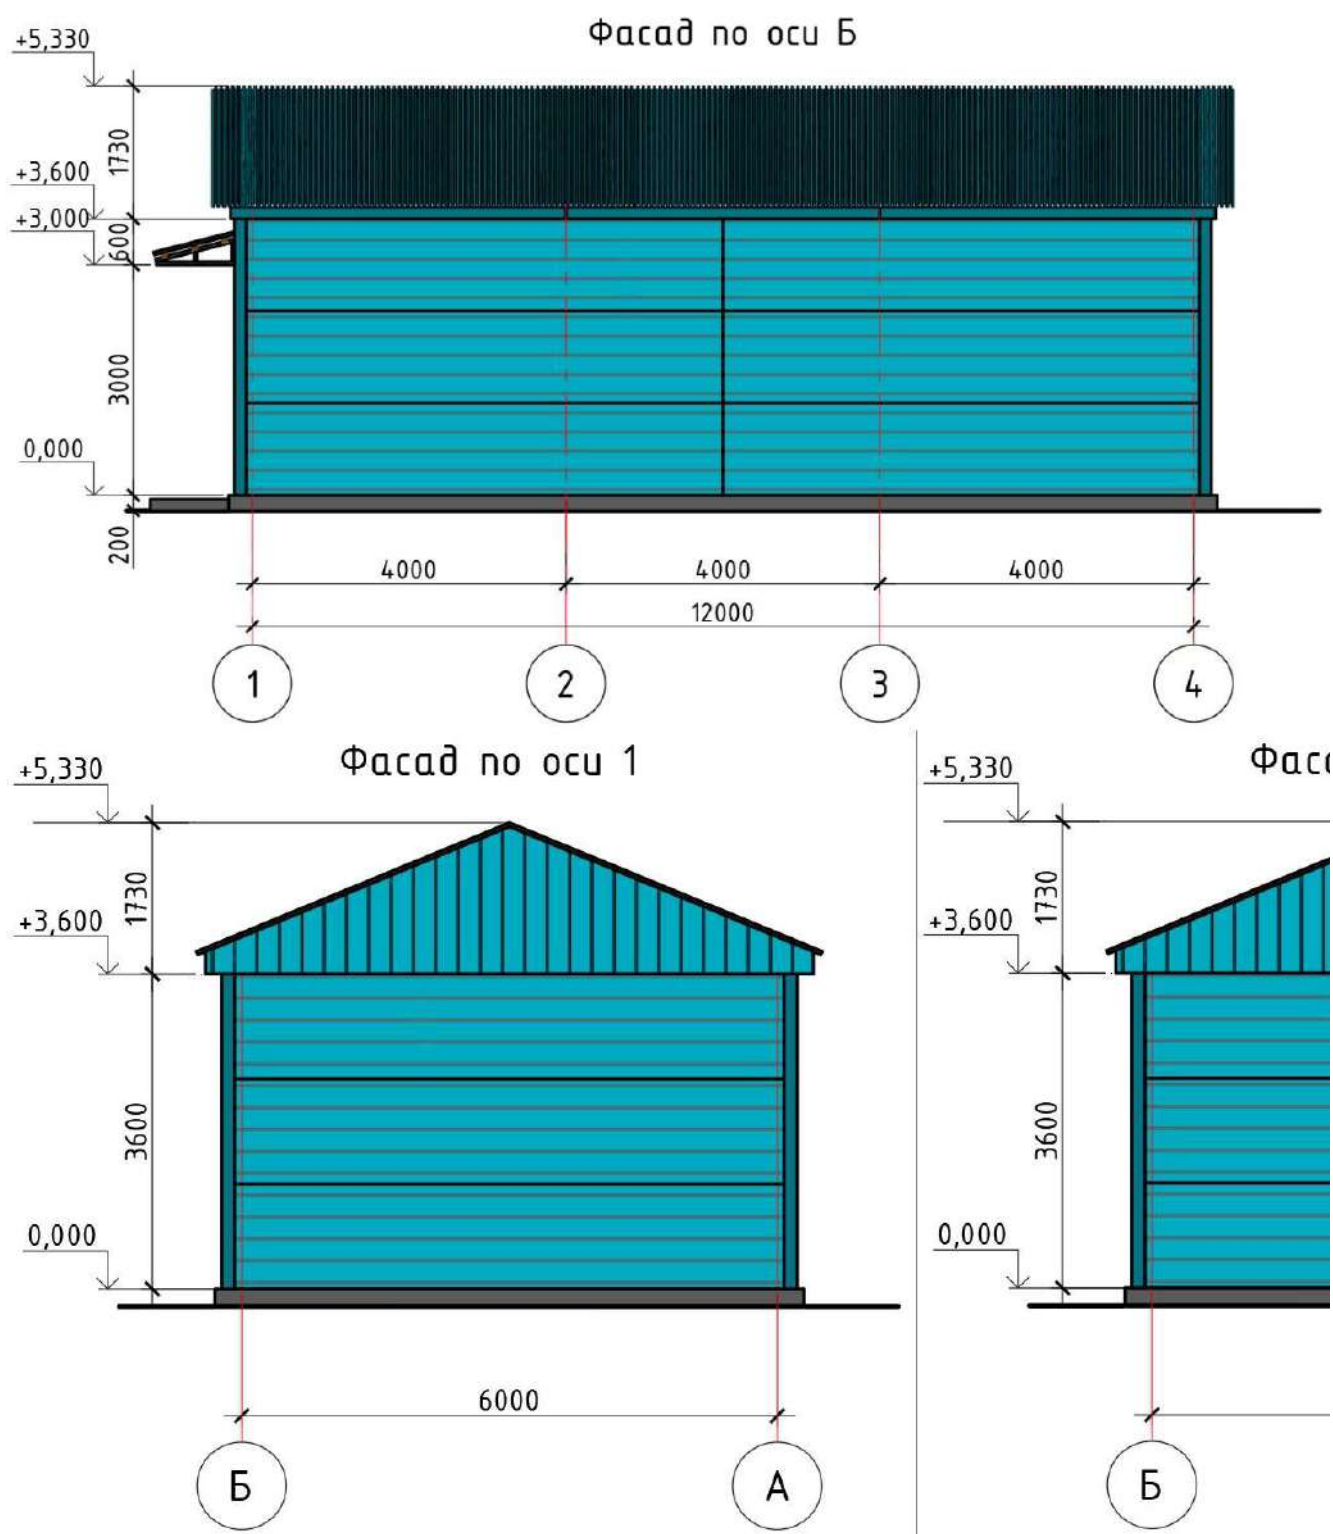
Фасад насосной станции водоснабжения и пожаротушения
